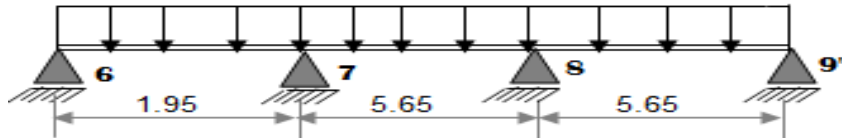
Schéma des poutrelles de sous-sol et RDC de bloc B
